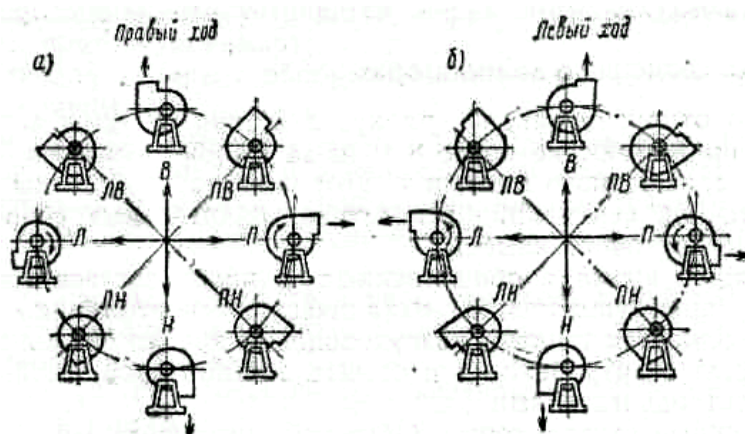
Положение выхлопного патрубка центробежных вентиляторов
